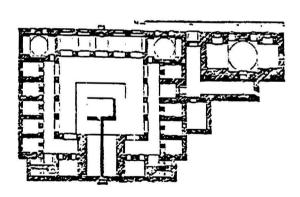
مسقط أفقي لمسجد أحمد المهمندار بالقاهرة (عن محمد حزة)
